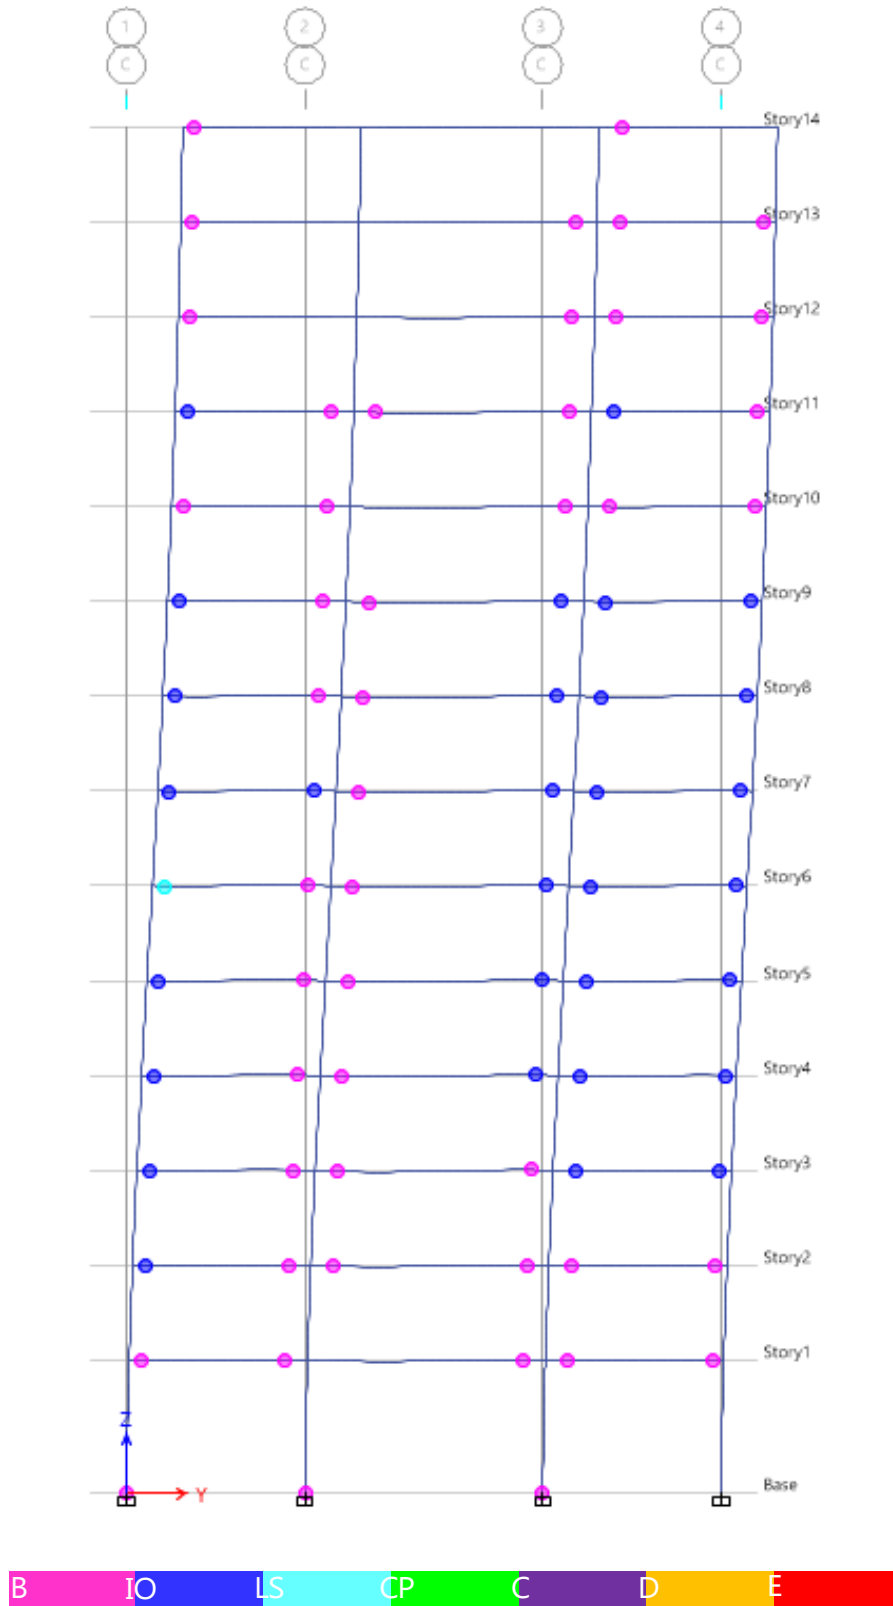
Formulación rótulas plásticas Eje D para BSE-2 en dirección y (Pórtico a momento hormigón armado NEC-11).
